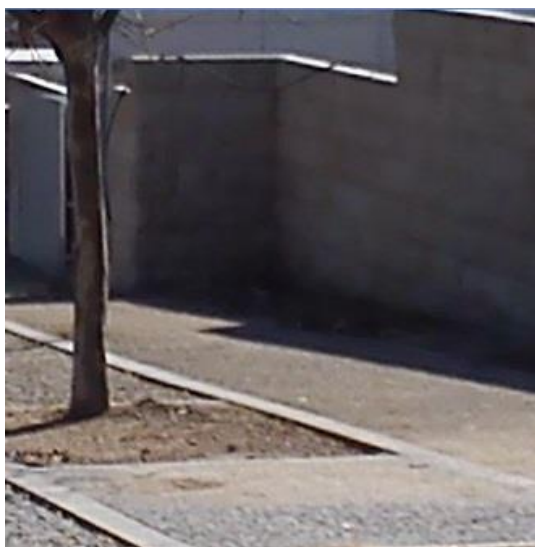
Inexistência de acabamento no pavimento exterior.
